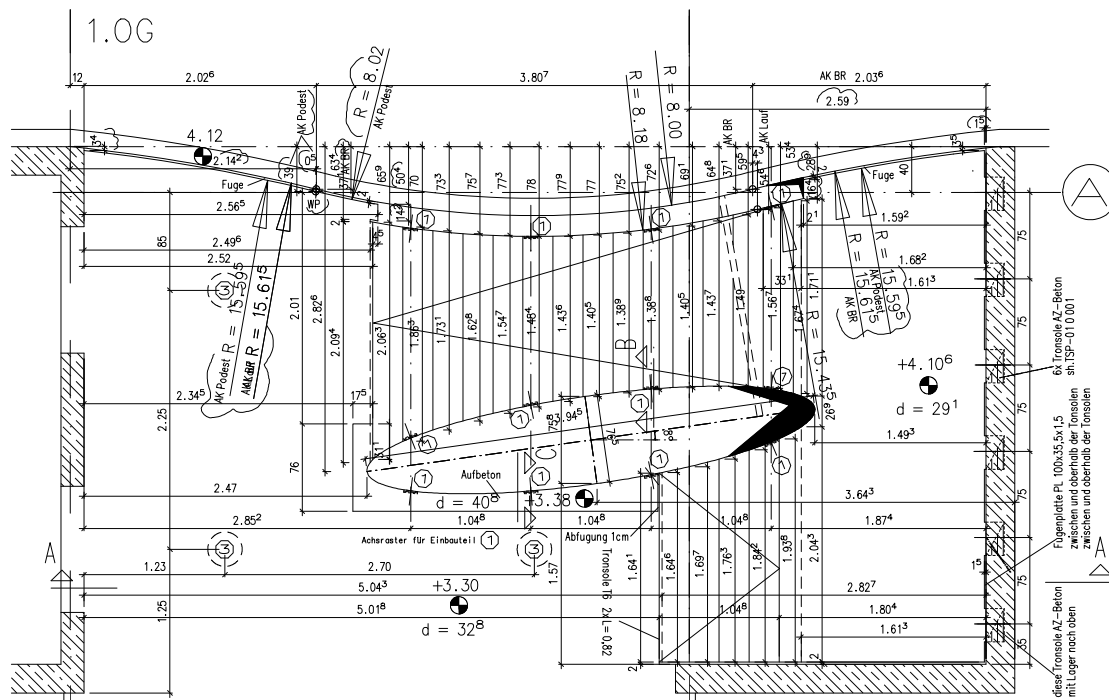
Grundriss Treppenhaus
